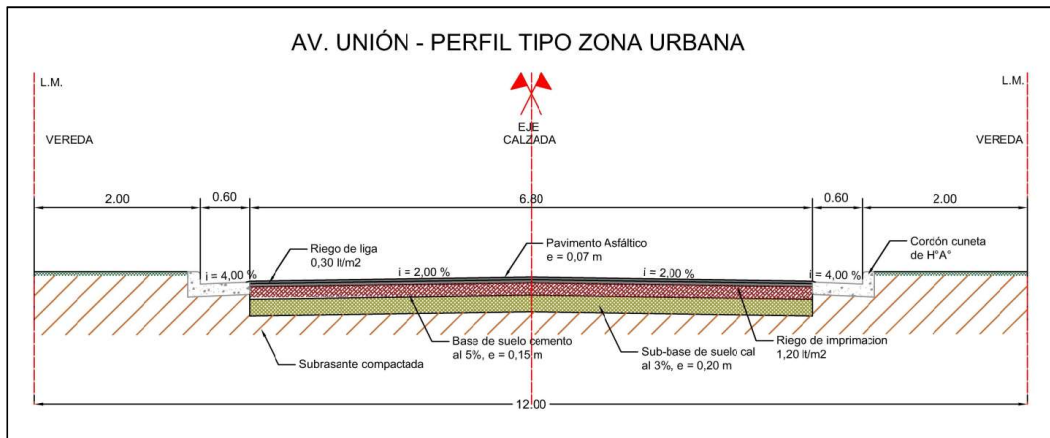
Sección transversal tipo de la Av. Unión en zona urbana
